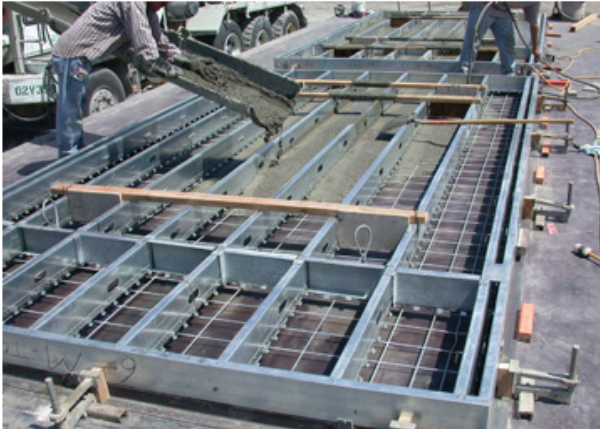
Operaciones de vertido del hormigón entre perfiles del bastidor ya conformado
